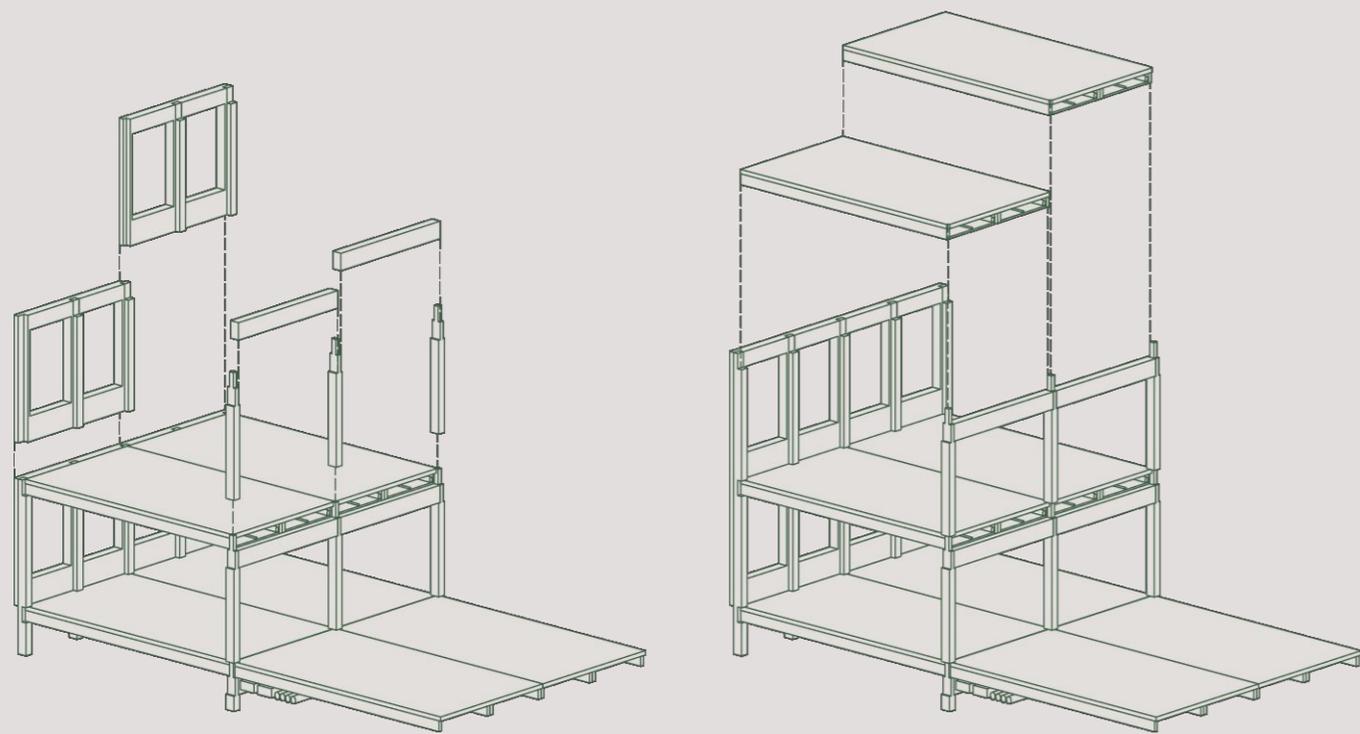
Axonometrie | Schema Fügung (Stützen/Fassadenelemente - Unterzüge - Deckenelemente)
